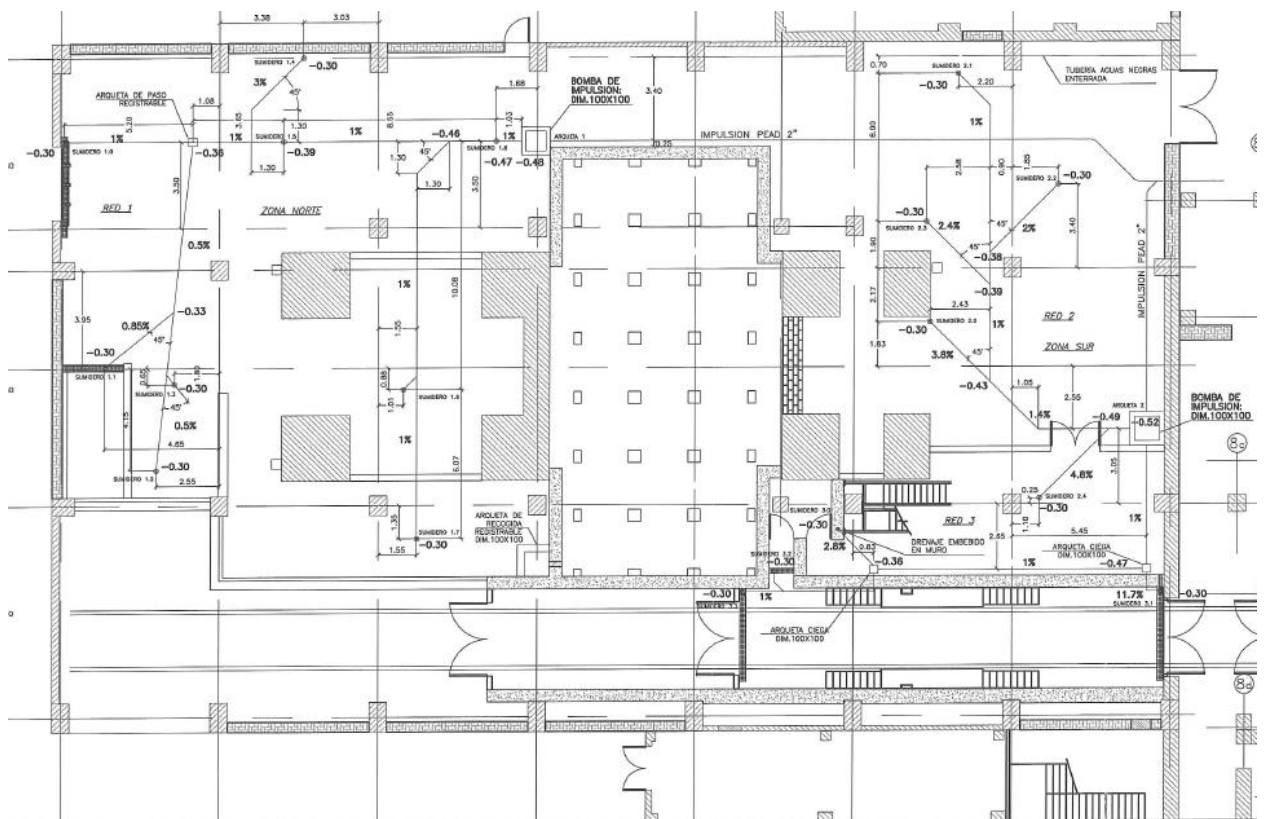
Disposición componentes del sistema de drenajes elevación +604.000
